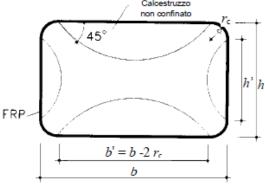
confinamento di sezioni rettangolari (Figura 4-13 di [1])
